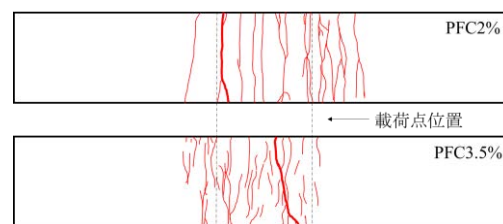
ひび割れ発生状況 (応力比 0.9)
